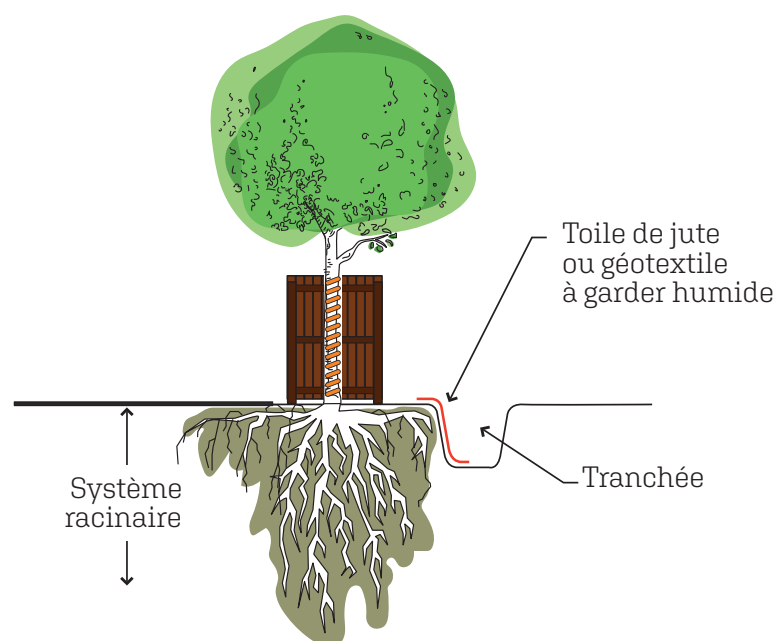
Protection du système racinaire en cas d'ouverture de fouille
